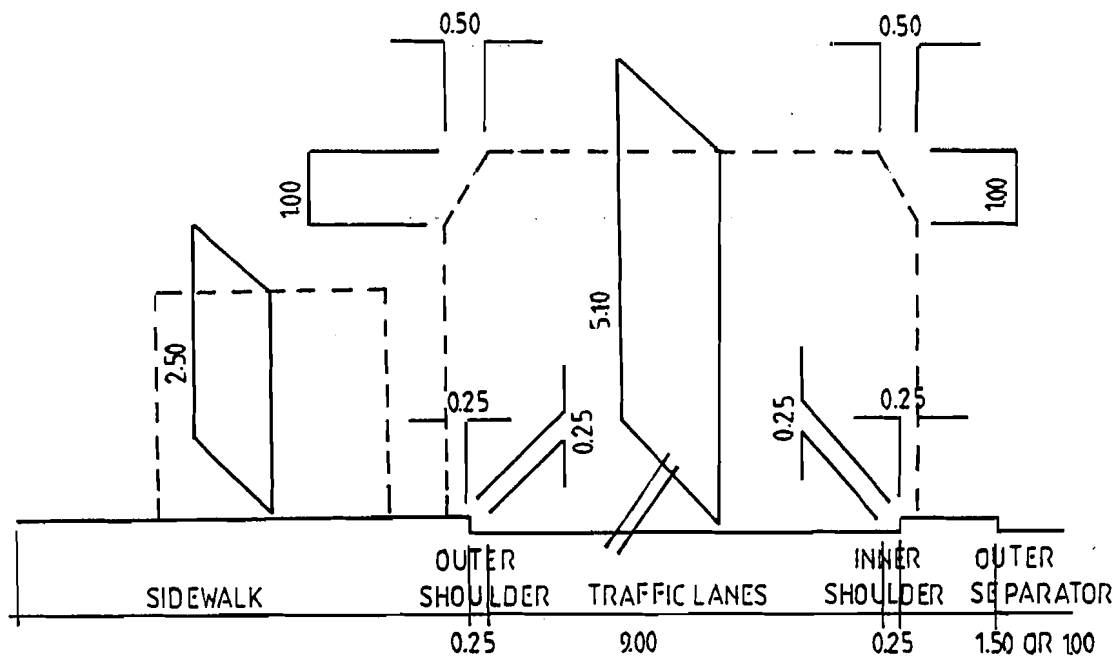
Ruang kebebasan Horizontal and Vertikal
